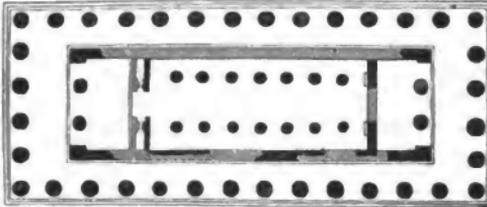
Grundriss des Poseidontempels zu Pästum.
